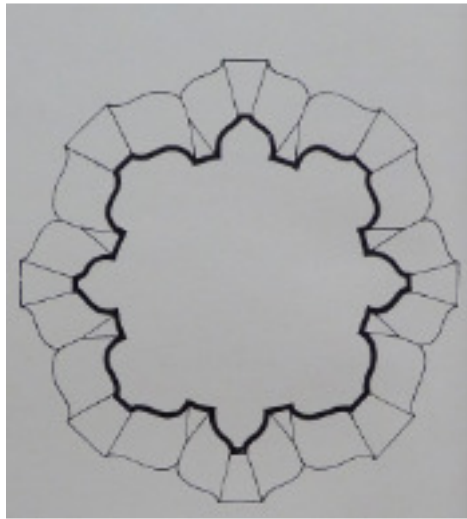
, Grundriss der Basis eines Pfeilers vom Mailänder Dom, Mailand.
